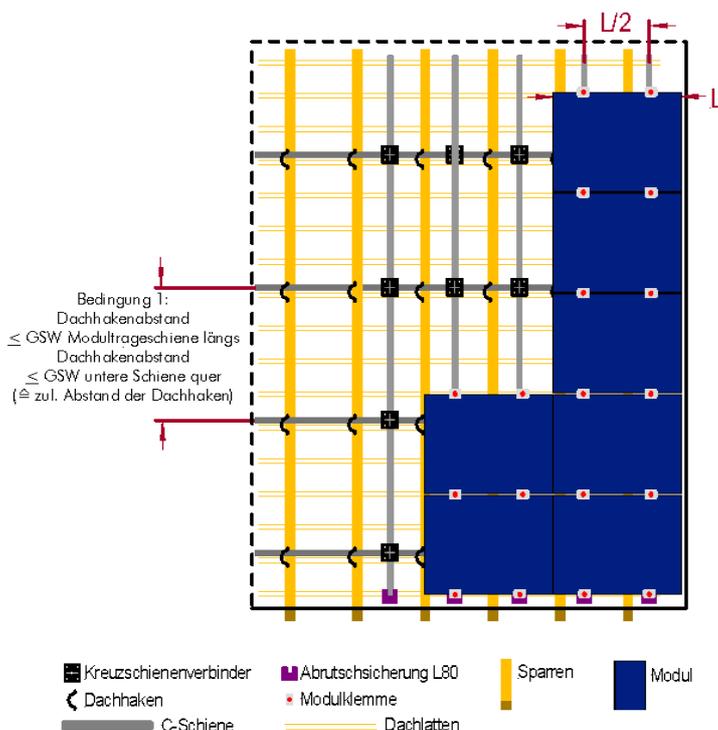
Prinzipskizze Modulquermontage mit Kreuzschienenverband
